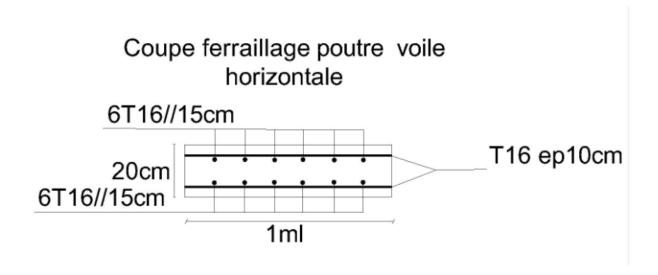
Coupe ferraillage poutre voile horizontale
